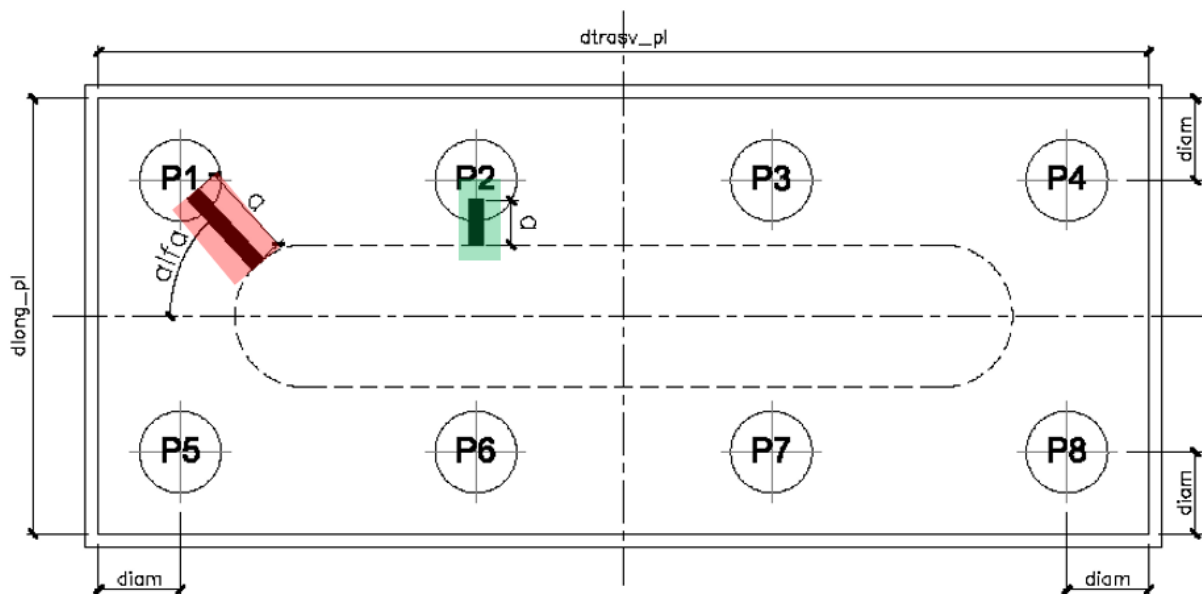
Vista in pianta - Tirante-puntone longitudinale (verde) e diagonale (rosso)
